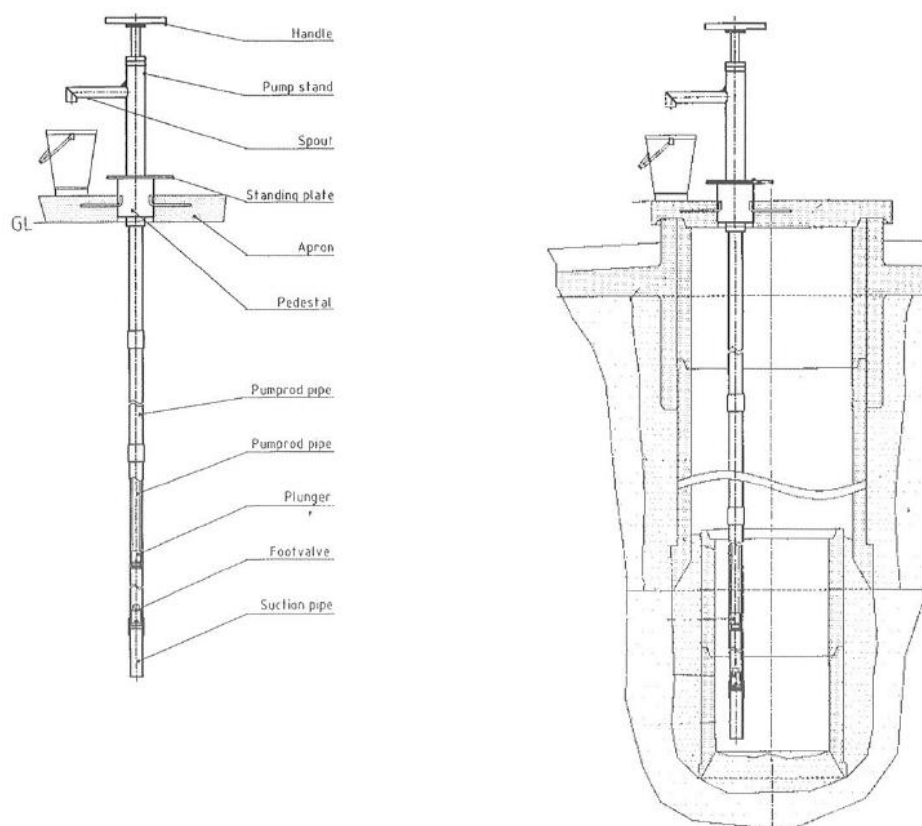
Instalación en pozo perforado/Instalación en pozo excavado (Anexo 2).
